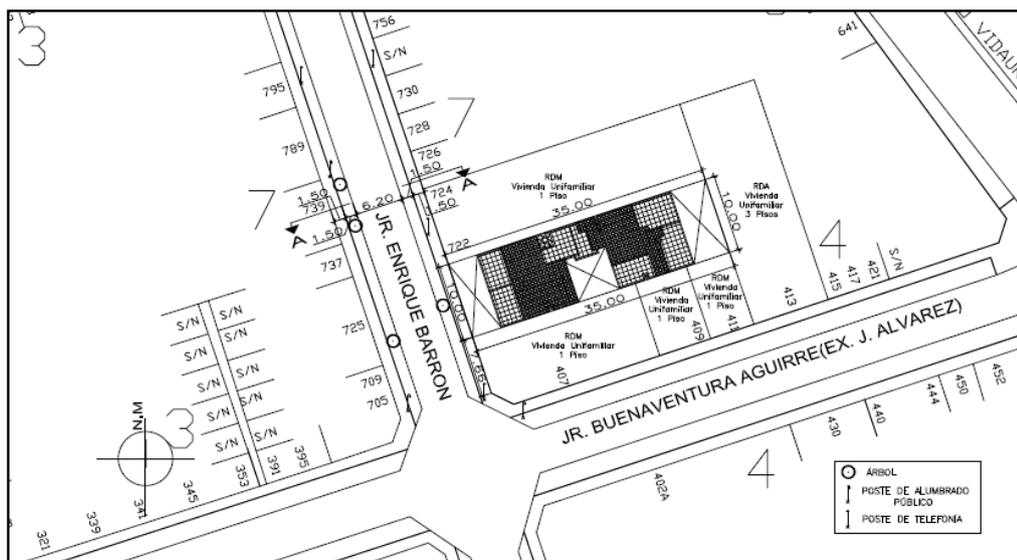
Plano de ubicación del Proyecto Baumhaus de Barranco, Lima.
